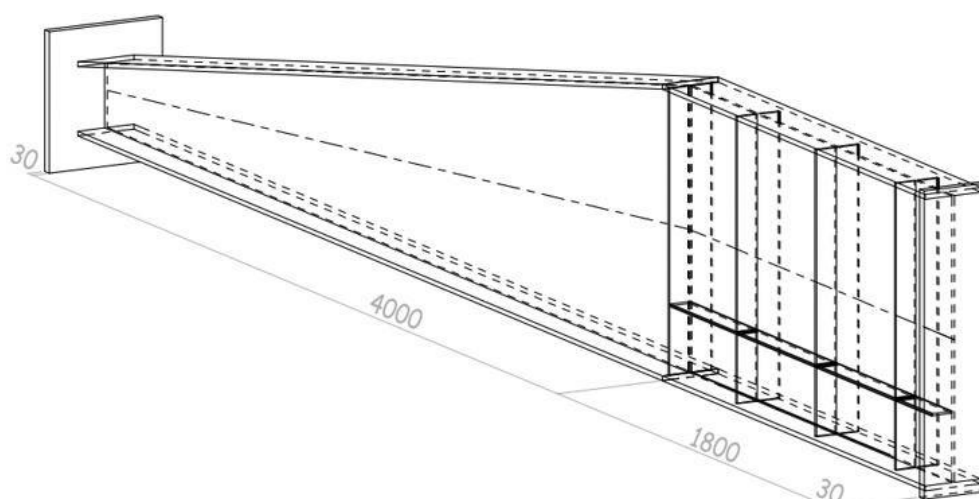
Esquema de configuração geométrica do elemento viga.
